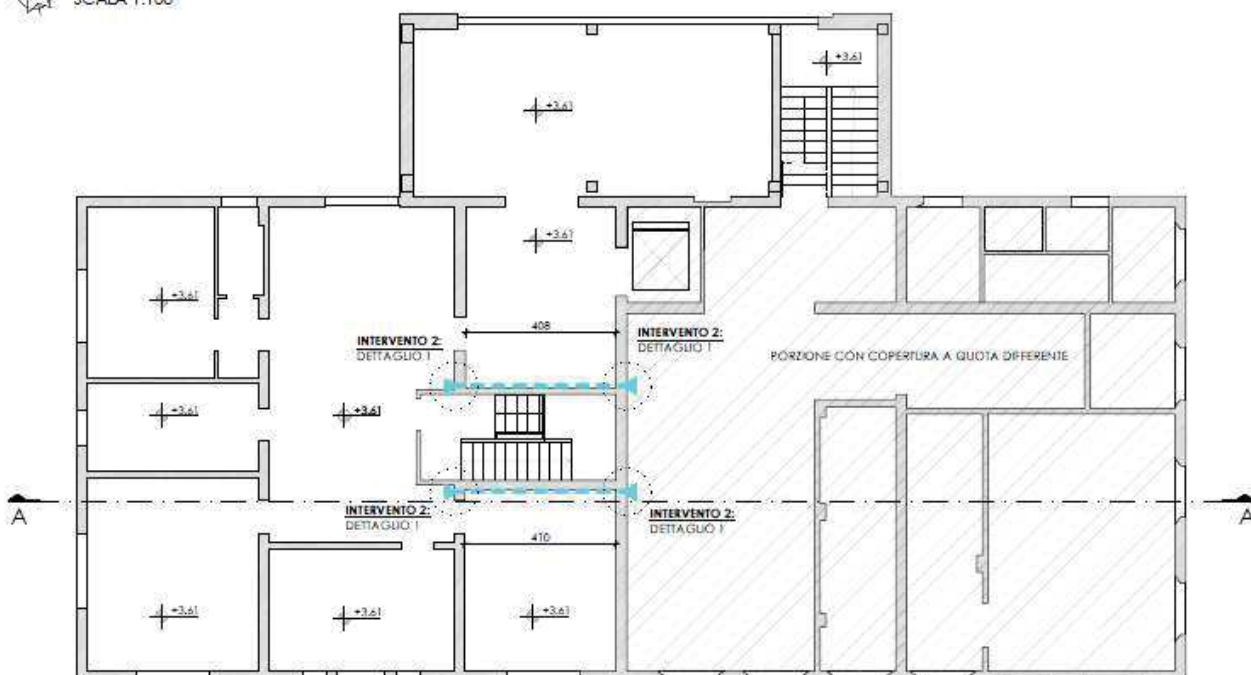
Pianta a quota +3.61m – Individuazione interventi
